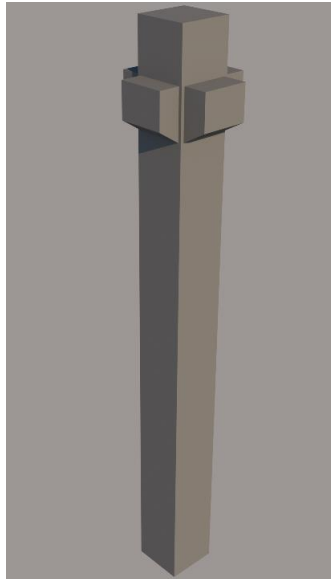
Columna con ménsulas. Elaboración propia. (2017).
